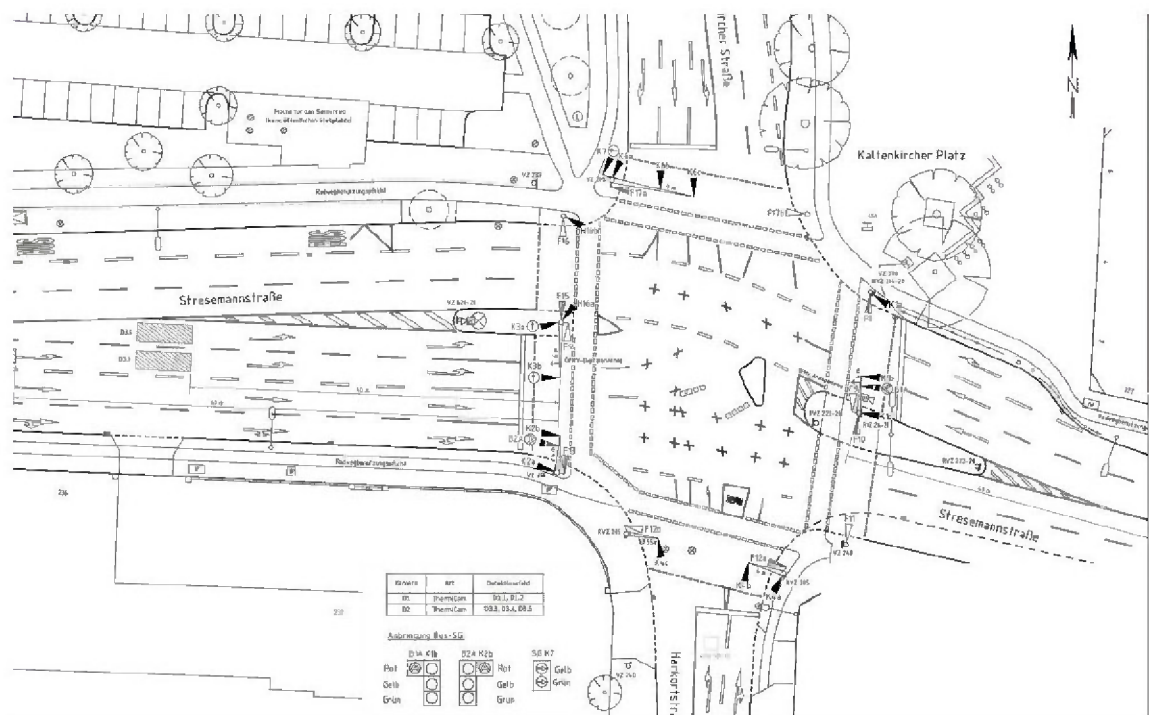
Signallageplan Stresemannstraße/Kaltenkircher Platz – Bestand (15/151-04-05/01)
